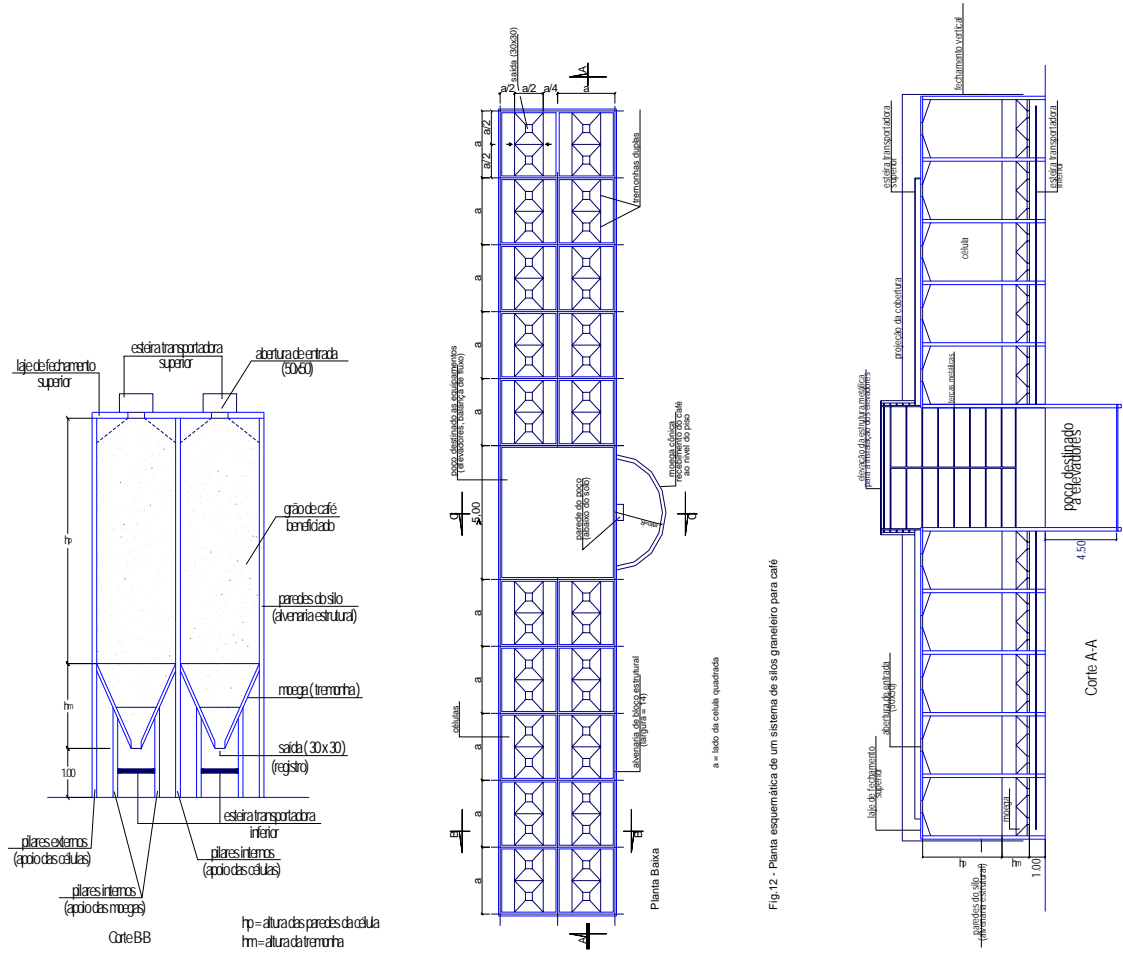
Sistema de silos em concreto armado e alvenaria estrutural
